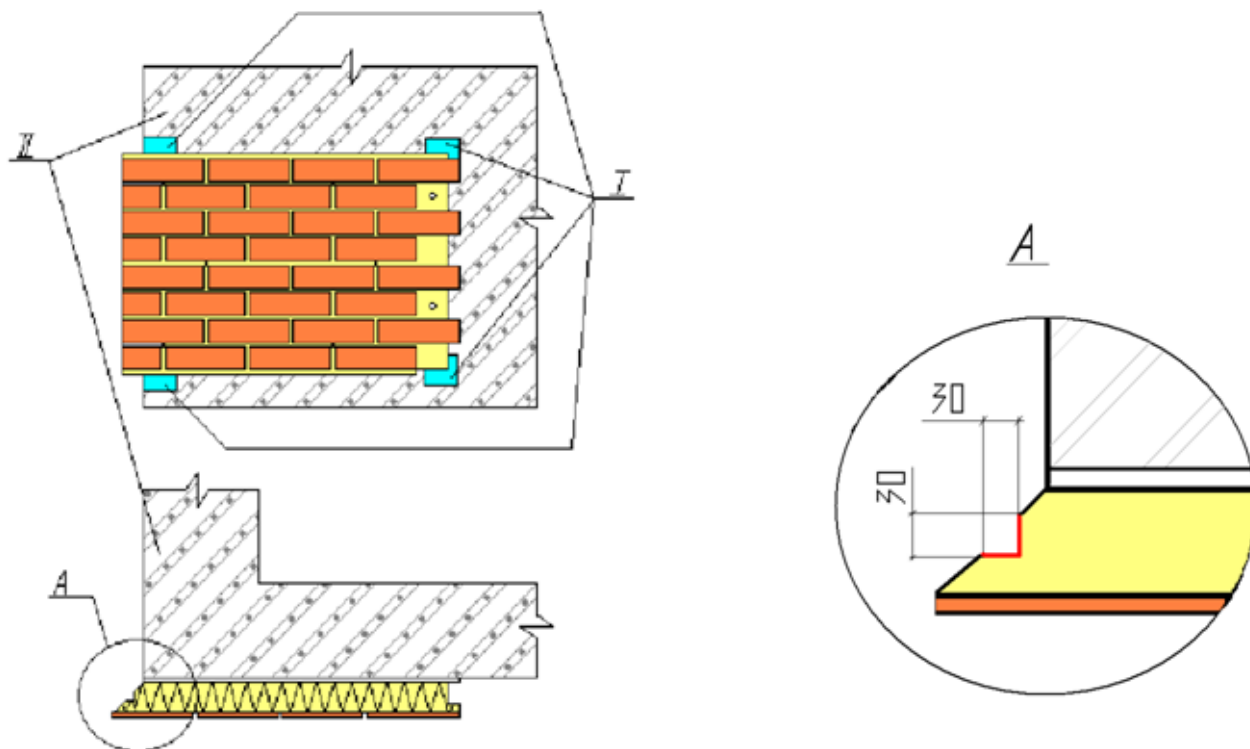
Установка фасадных элементов (I-вертикальные маяки, II- основание).
